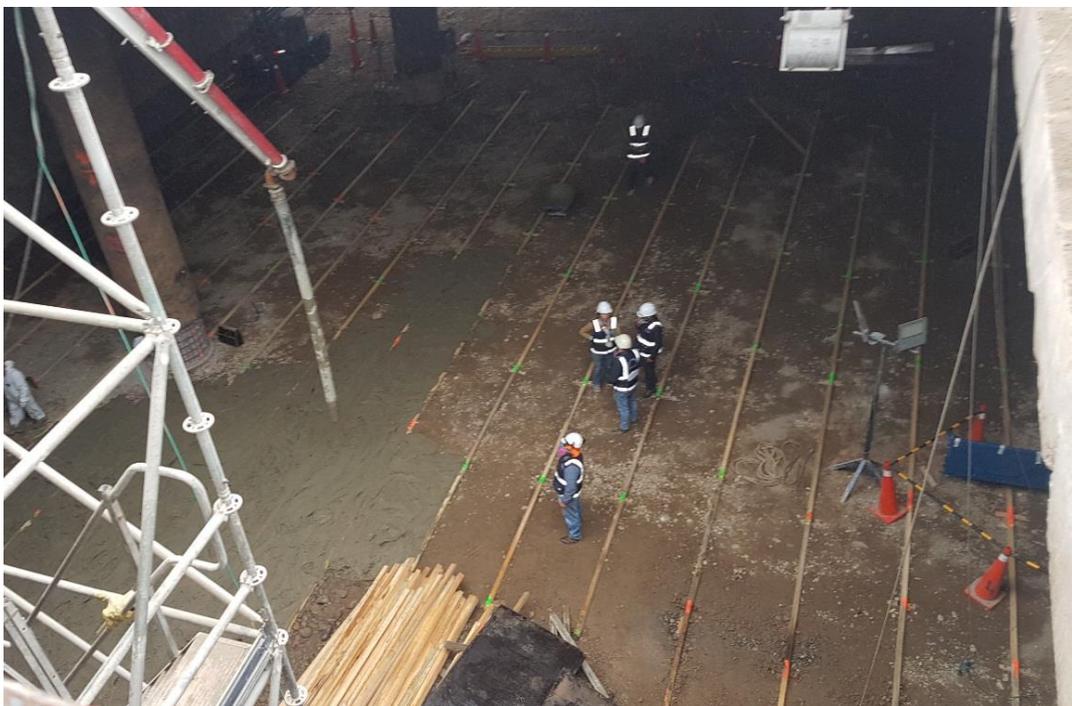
Proceso de trabajos de encofrado perdido sobre terreno.
